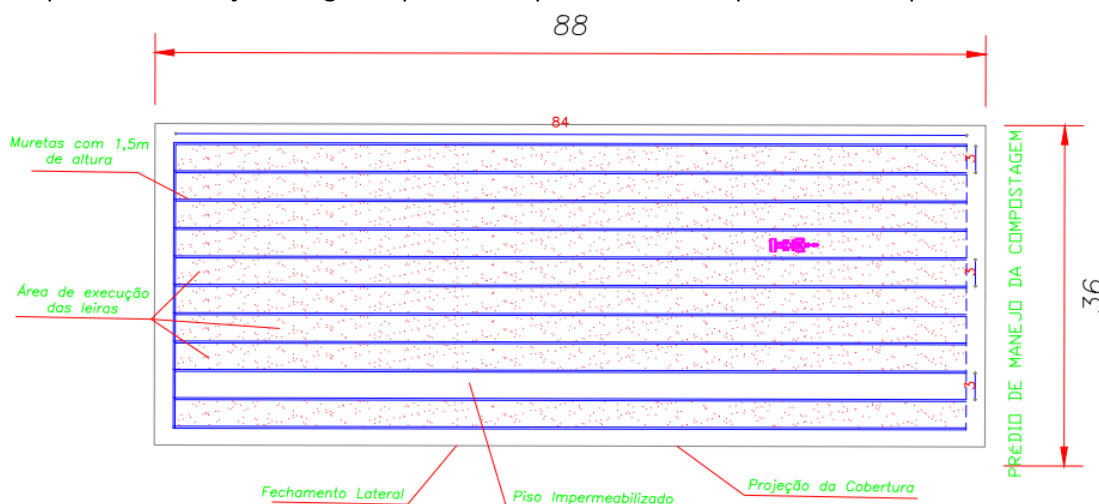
Planta baixa do Pavilhão Destinado às Leiras
